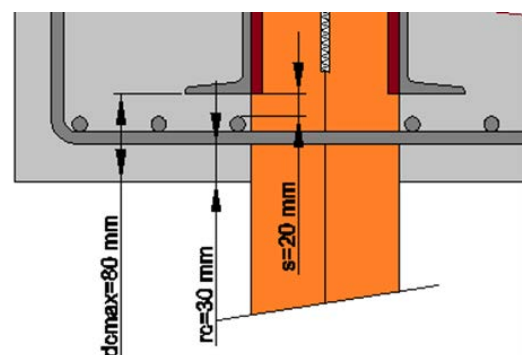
Sección transversal indicando dimensiones orientativas en la parte inferior de la viga en presencia de capiteles metálicos.
